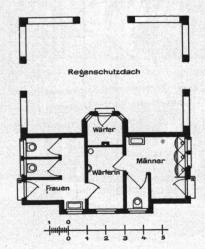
Bedürfnisanstalt mit Regenschutzbach in ben Grünanlagen im Eilbecktal, Grundriß.
